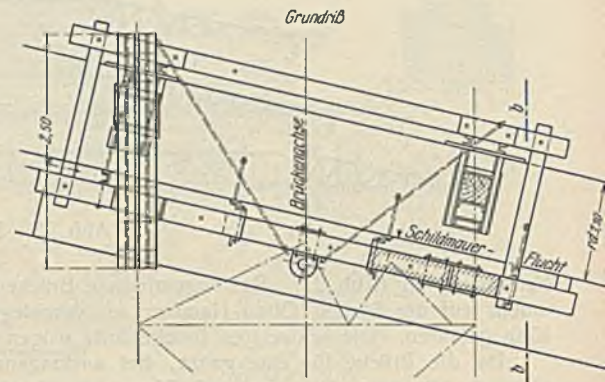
Grundriß des Unterstüztungsgerüsts beim linken Ufer (Abb. 30).
